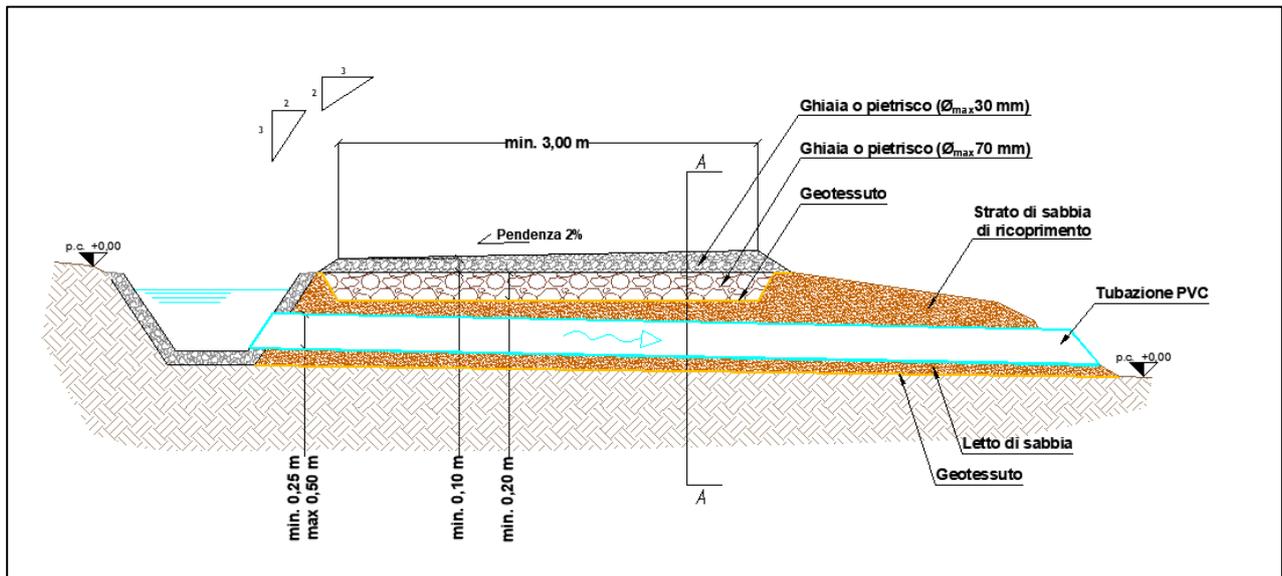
Tipologico sezione stradale viabilità interna con attraversamento tubo di drenaggio acque meteoriche
